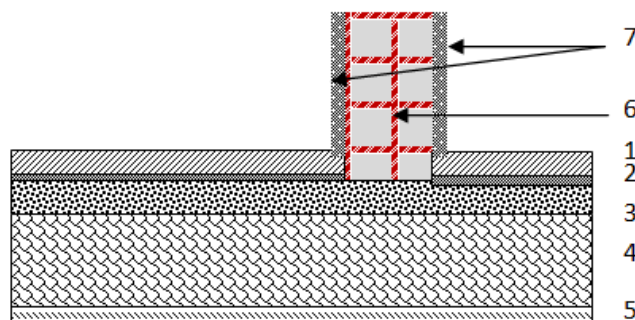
Coupe verticale d'un plancher étage courant (corps creux).
